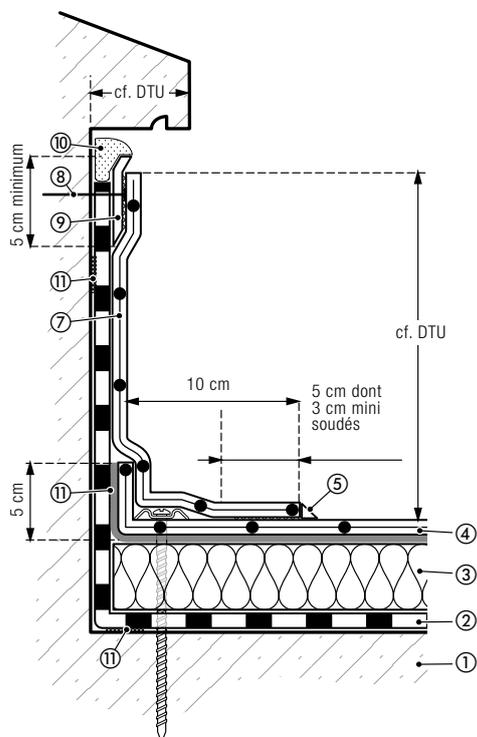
Relevé d'étanchéité de hauteur ≥ 200 mm avec fixation intermédiaire et avec pare-vapeur polyéthylène sur maçonnerie
